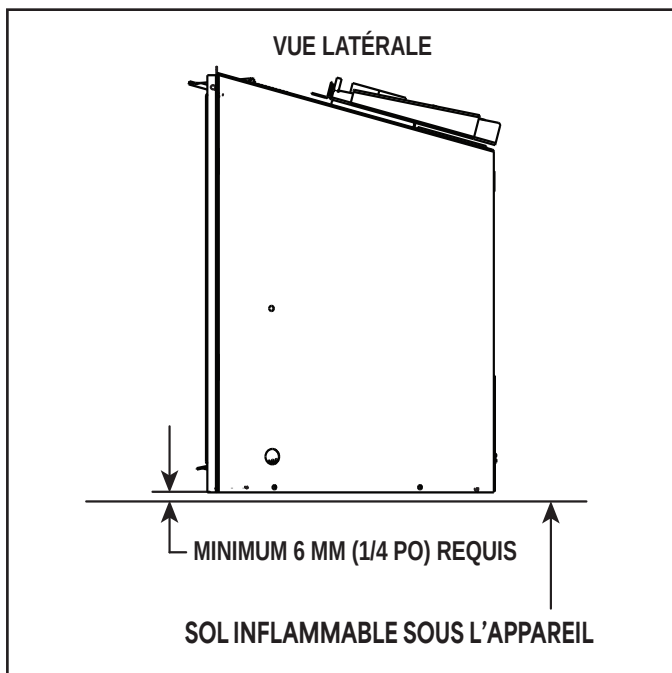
Dégagement par rapport au sol pour combustible solide
